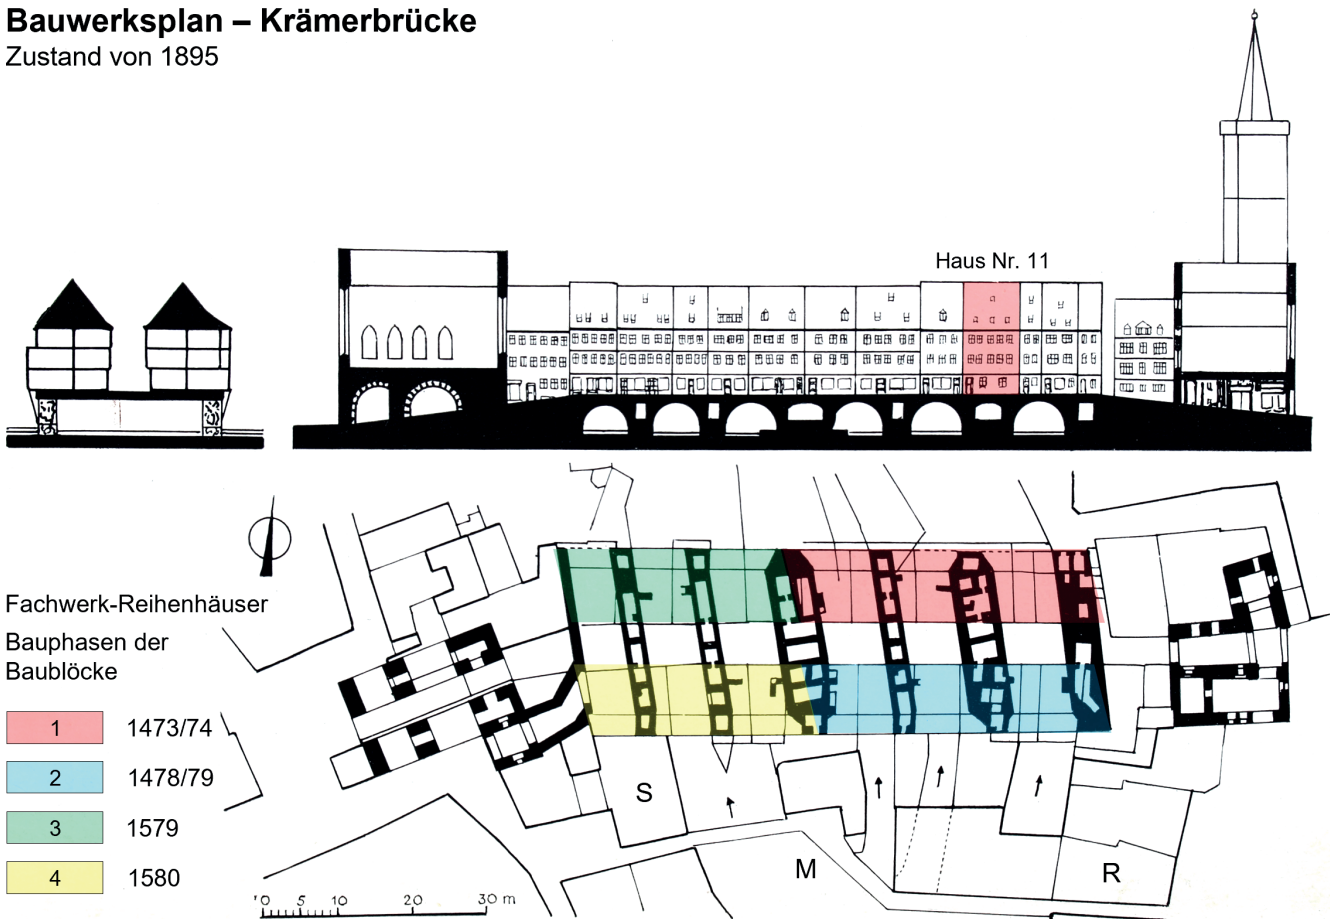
Bauwerksplan der Krämerbrücke im Zustand von 1895 mit Darstellung der Bauphasen zur Errichtung der Fachwerk-Reihenhausbaublöcke
